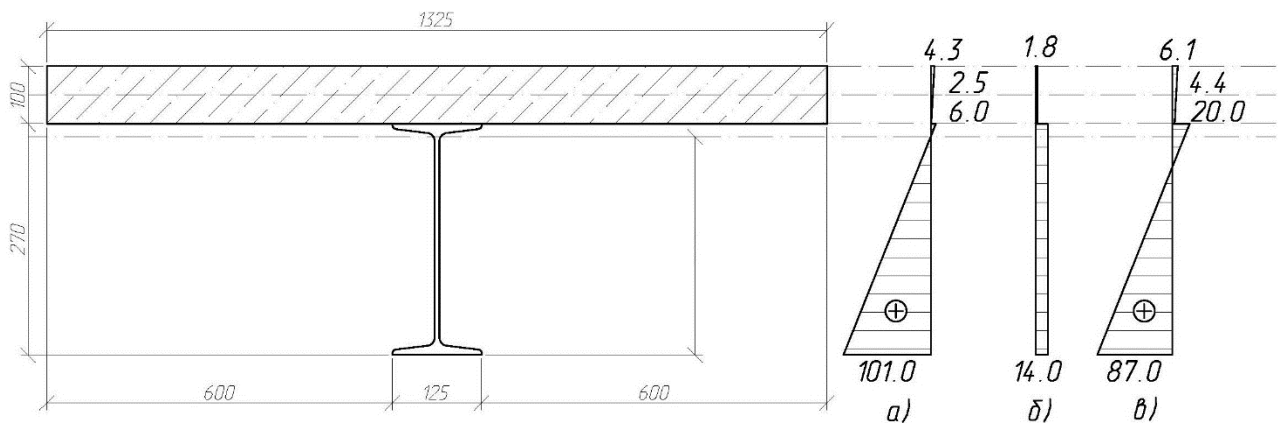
Епюри напружень у перерізі верхнього поясу СЗШК по середині прольоту (приведений переріз), МПа: а) від дії згинальних моментів; б) від поздовжньої сили; в) сумарна епюра.
